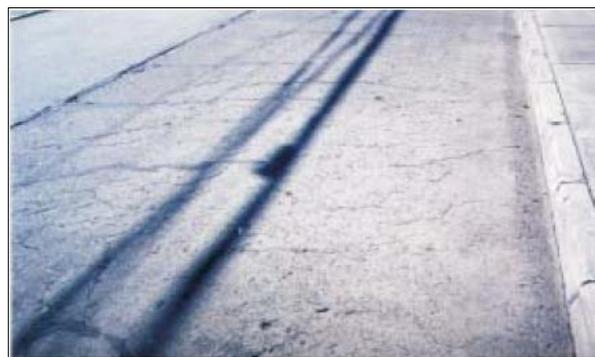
Fisuramiento por retracción (DIRCAIBEA, 2000).
